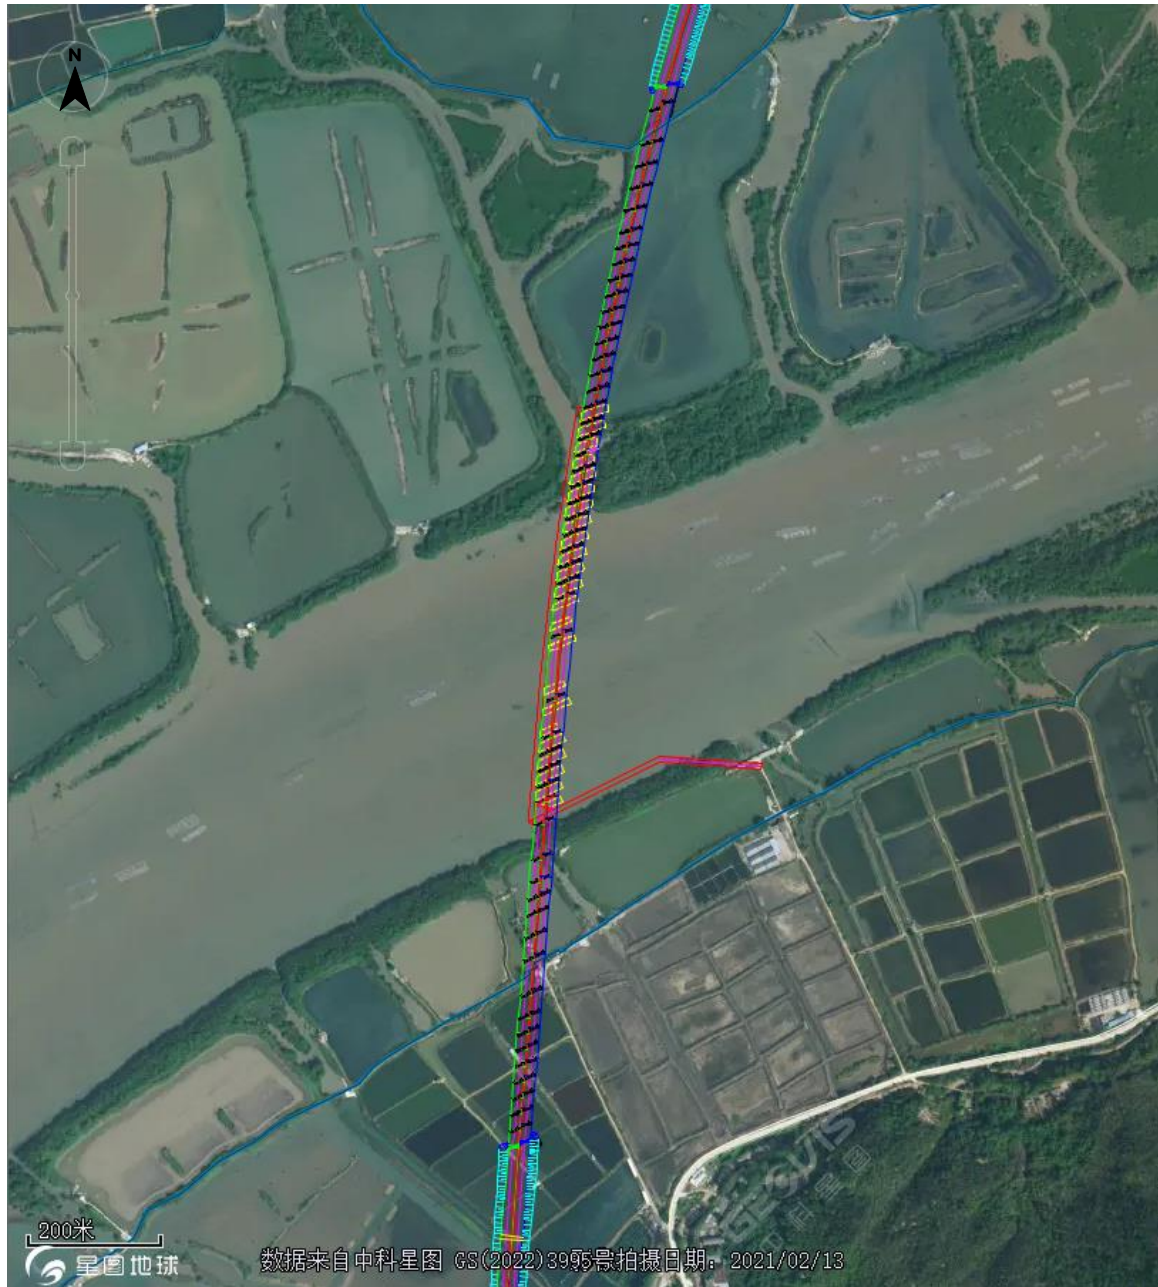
大桥及施工栈桥总平面布置处卫星遥感影像
